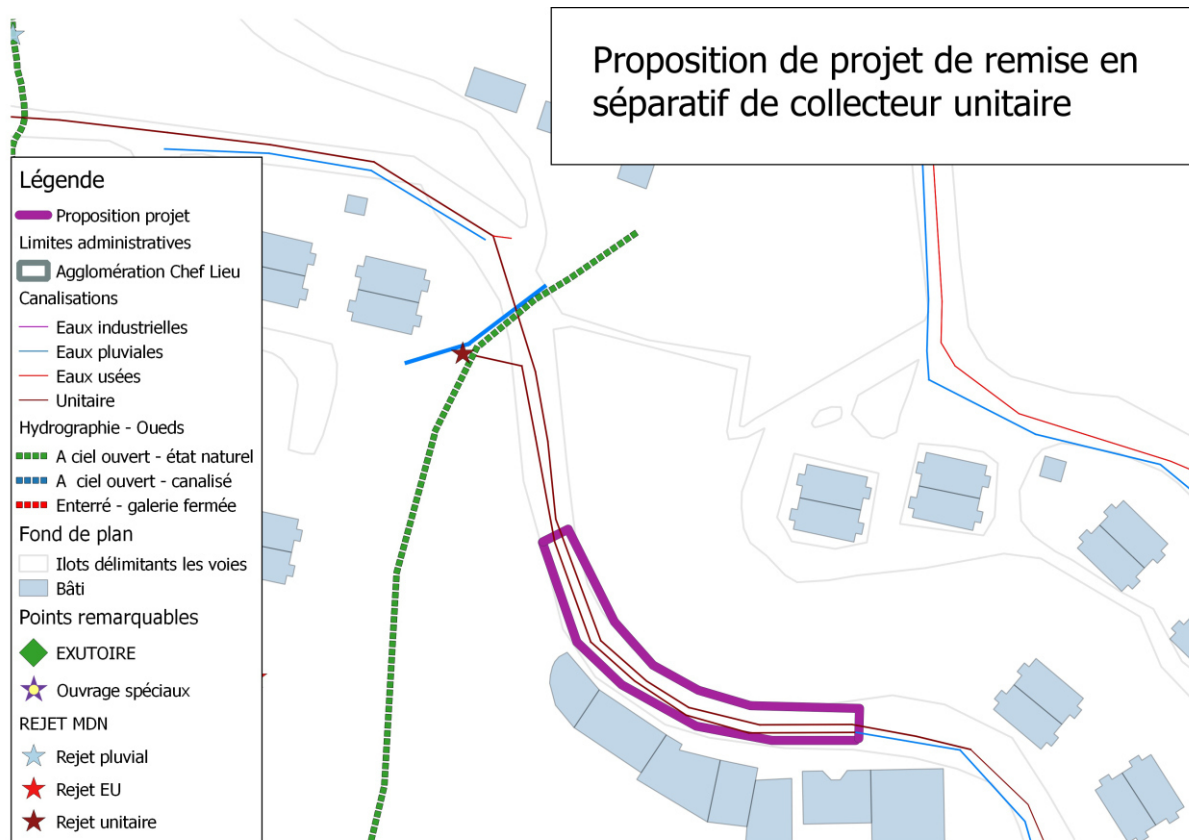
Proposition de projet de remise en séparatif d'un collecteur pluvial contaminé (unitaire)
